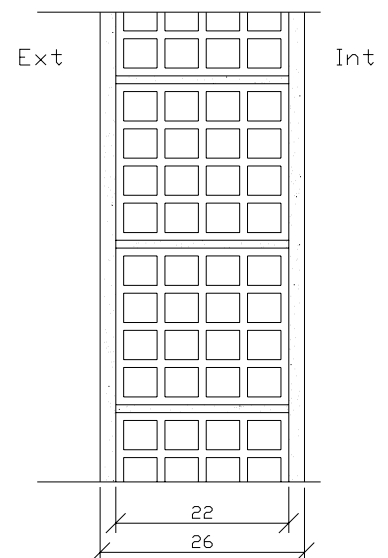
Parede simples em tijolo perfurado rebocada nas duas faces
